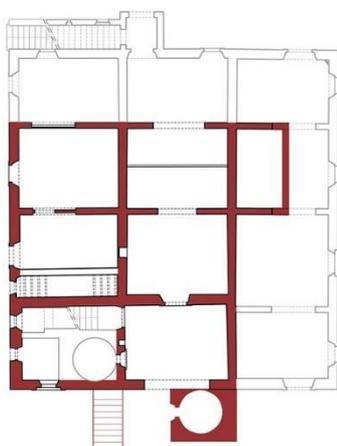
Sovrapposizione pianta del 1779, in rosso, su pianta PT allo stato di fatto. [rielaborazione dell'autrice, estratto Tav. 2]
